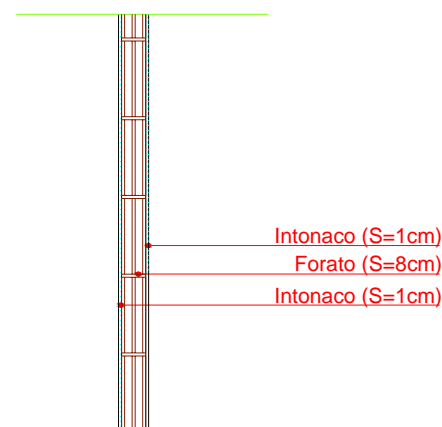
Dettaglio del tramezzo interno (sezione orizzontale).
